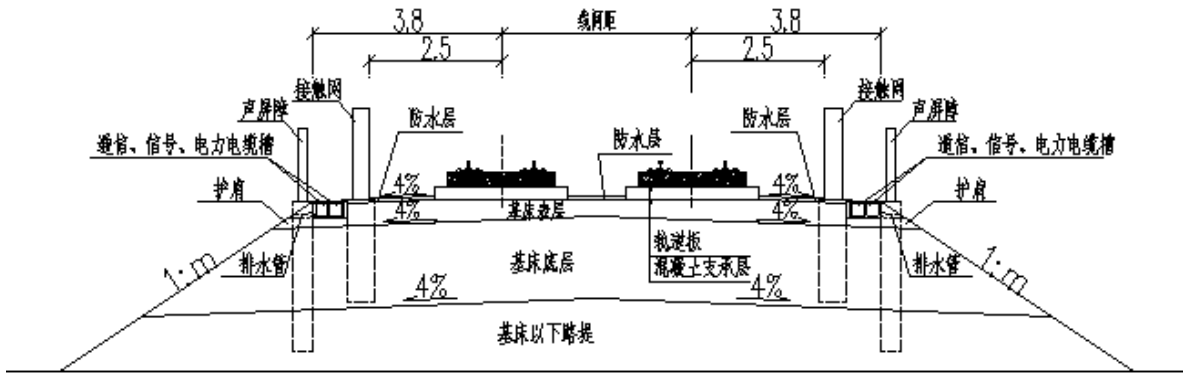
无砟轨道双线路堤横断面示意图（单位：m）
